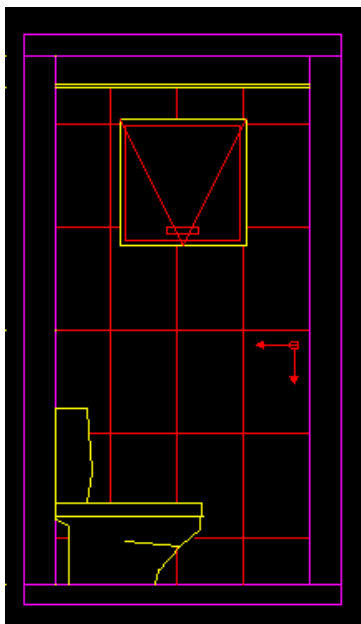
Elevação “A” – Banheiro, parede cerâmica
